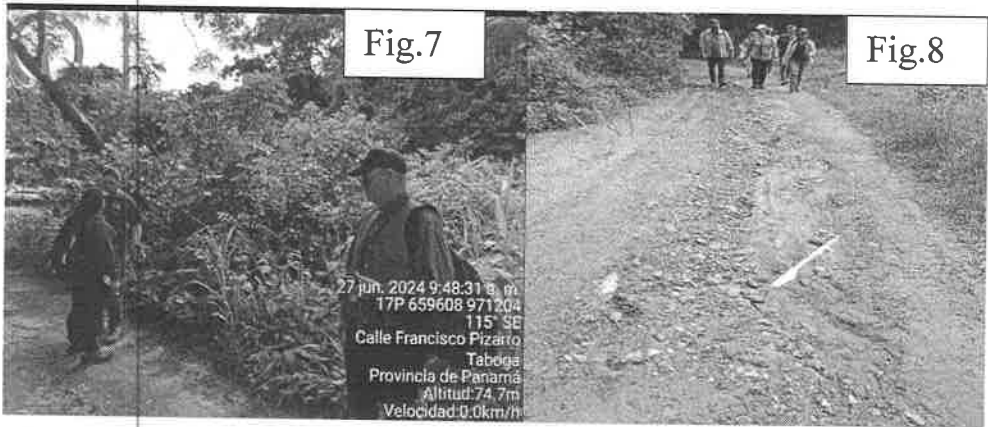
Fotografía que evidencia la finca adyacente a donde se ubica la Planta existente, que es donde se construirá la Nueva Planta Desalinizadora. La misma contará con oficinas administrativas y laboratorios, a diferencia de la planta existente. En cuanto a la vegetación se pudo observar que está conformada mayormente por vegetación de bosque joven y rastrojos, algunos árboles de las especies de Guácimo, Niguita, Guarumo, entre otros. Se indicó la afectación de la vegetación en su totalidad. Según lo indicado en campo, uno de los objetivos de la nueva planta desalinizadora, es que la Isla Taboga, pueda contar con una planta operativa, en momentos, donde la planta existente requiera trabajos de mantenimiento preventivos y correctivos, de tal manera que la población existente no se vea afectada por el abastecimiento de ese recurso vital.
